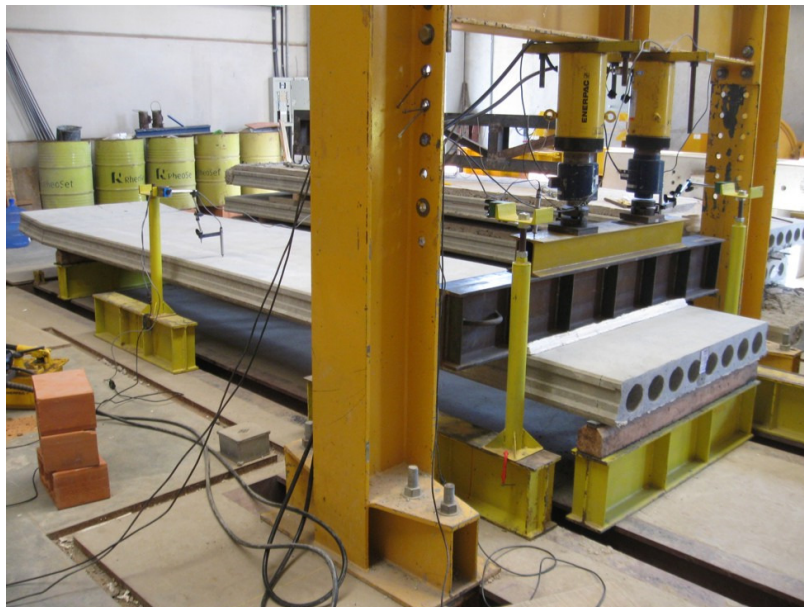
Foto do ensaio de cisalhamento da laje EM3-L4-A.
